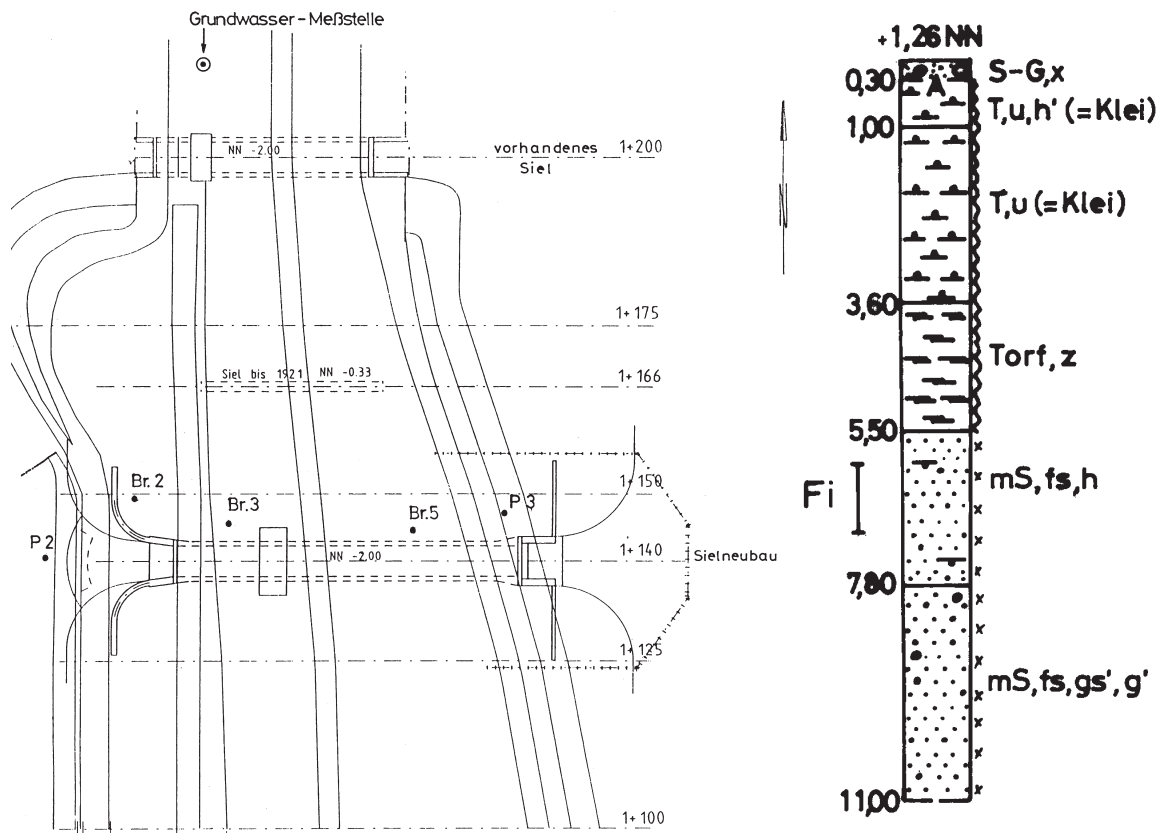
Lageplan mit Bohrprofil und Lage der Filterstrecke am Laglumsiel/Föhr
